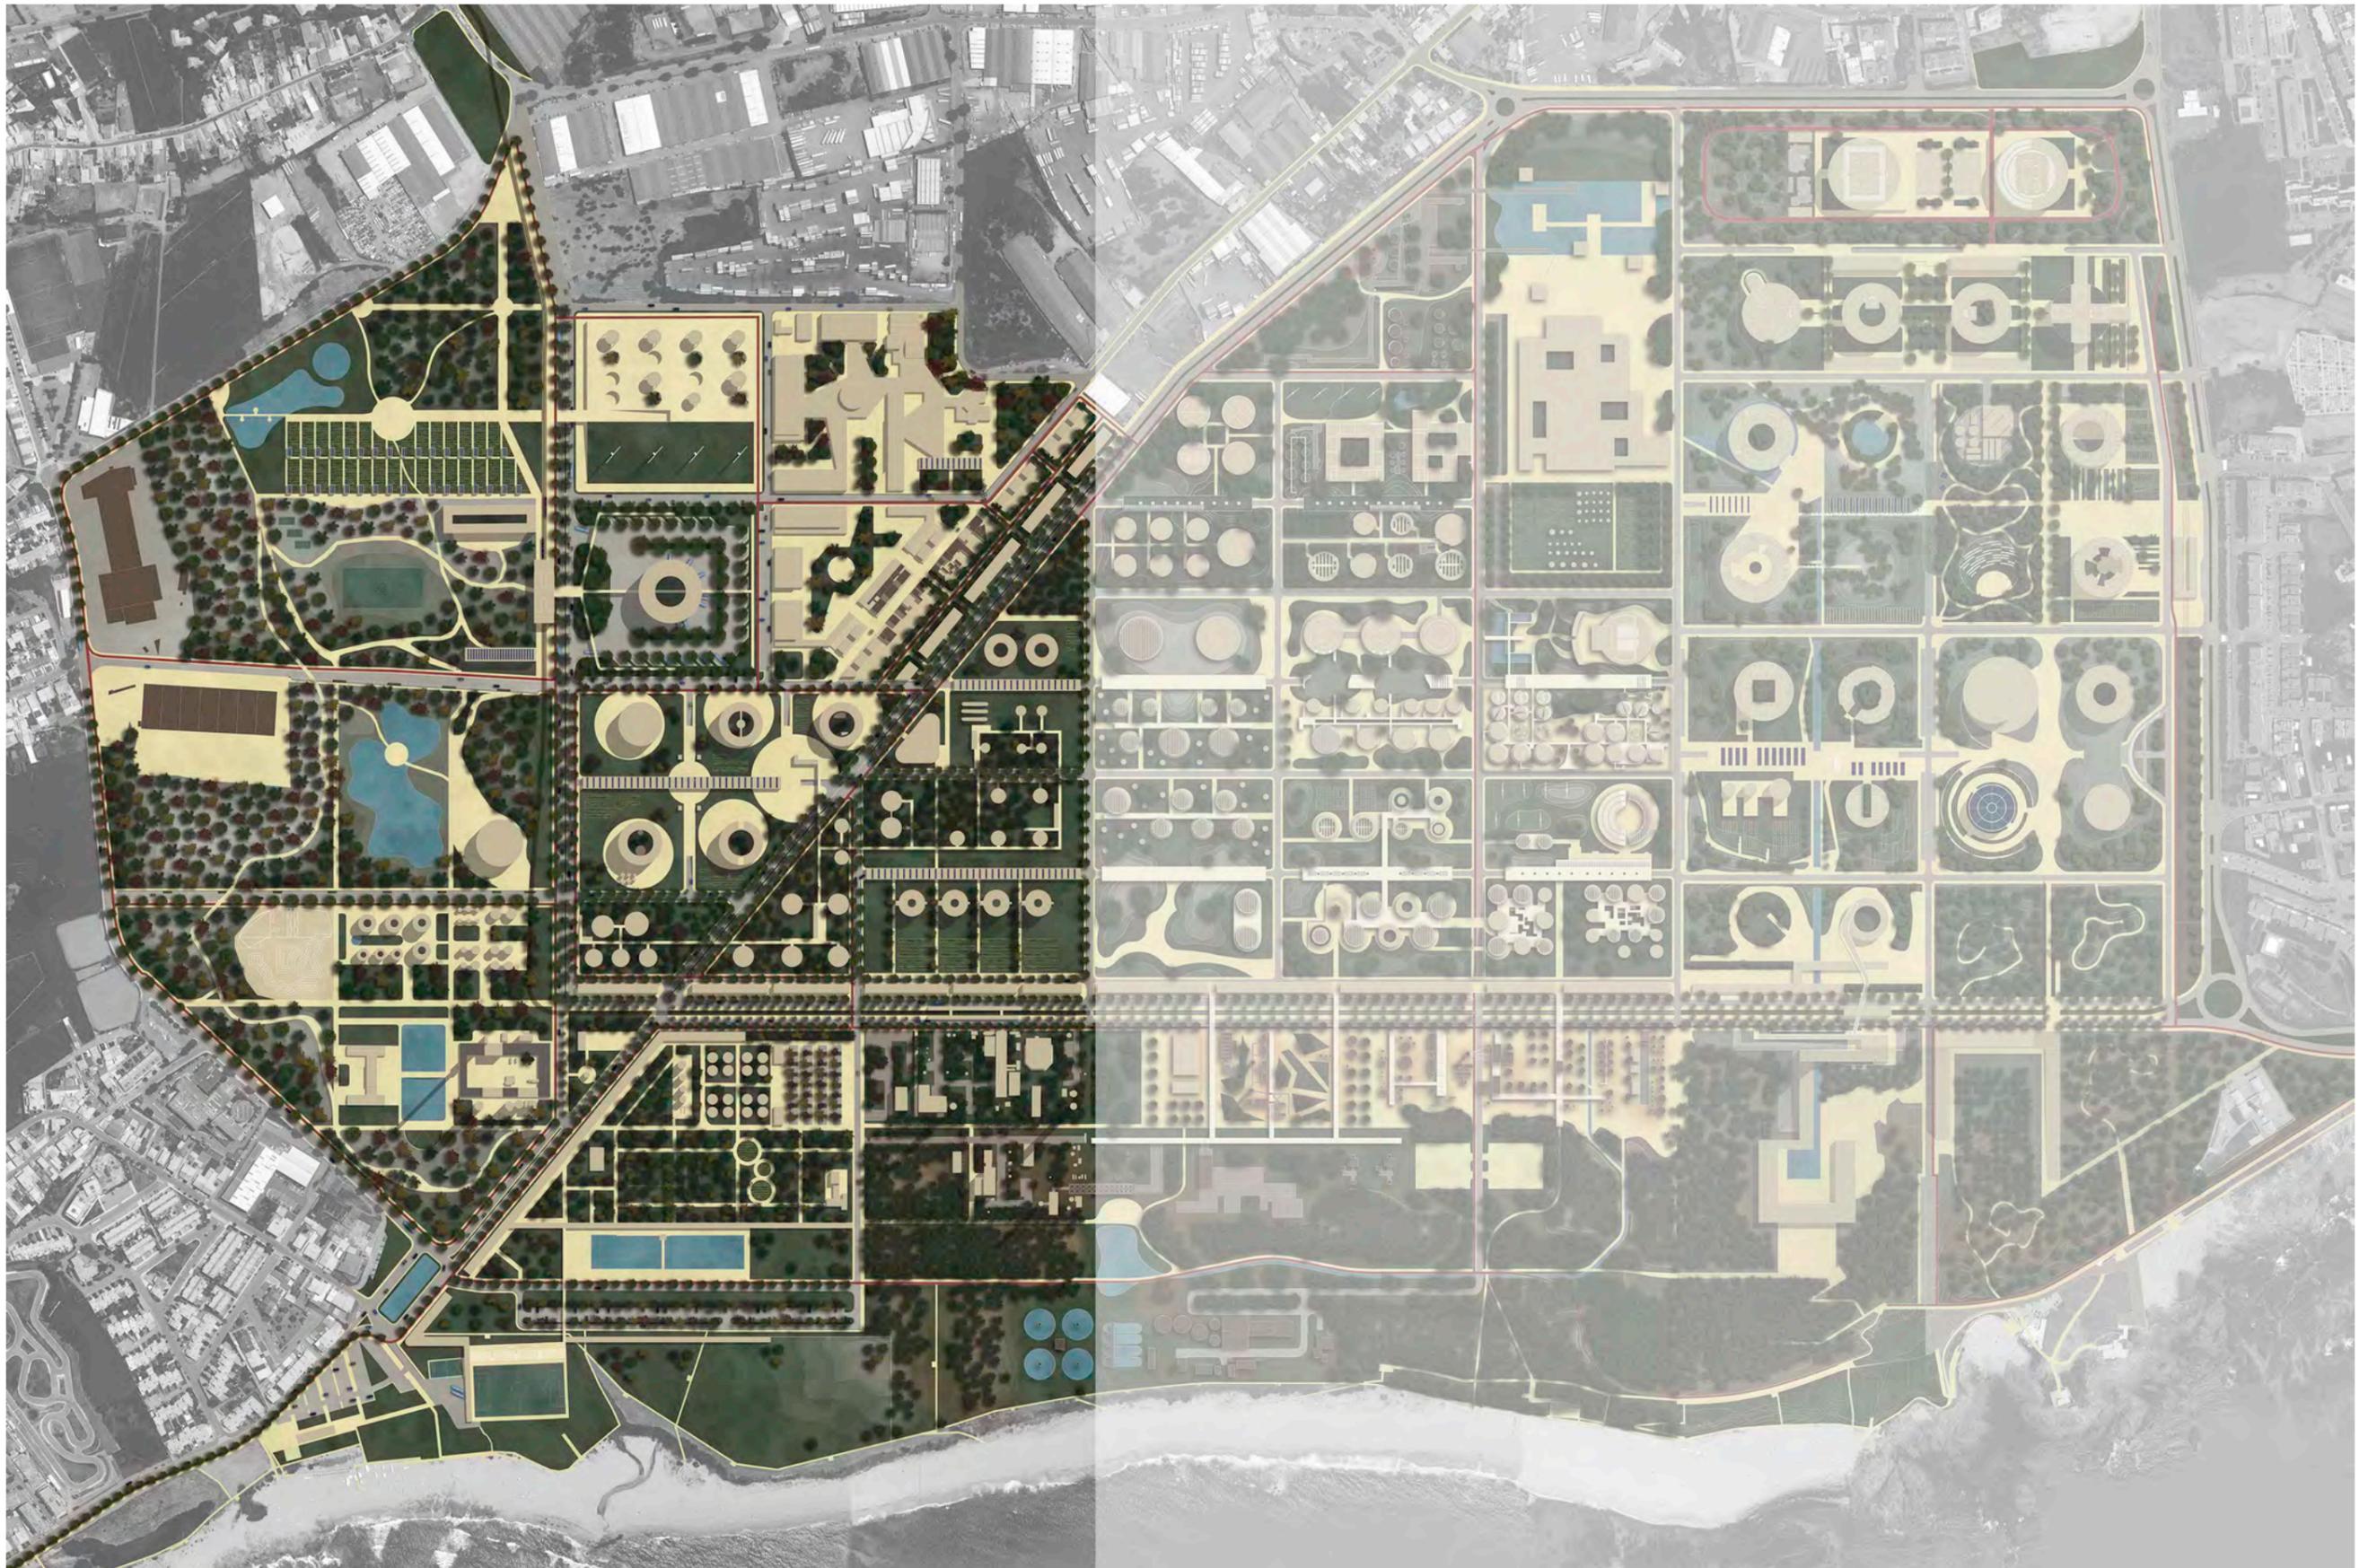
Planta da Proposta de Grupo à escala 1.7000
